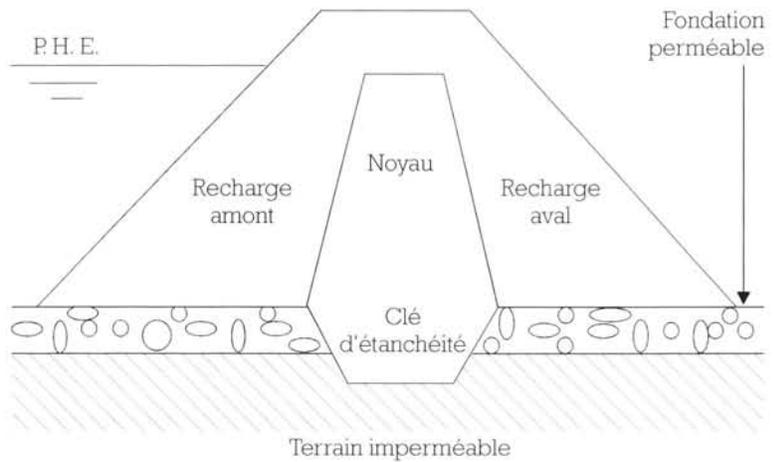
Clé d'étanchéité d'un barrage à noyau.
